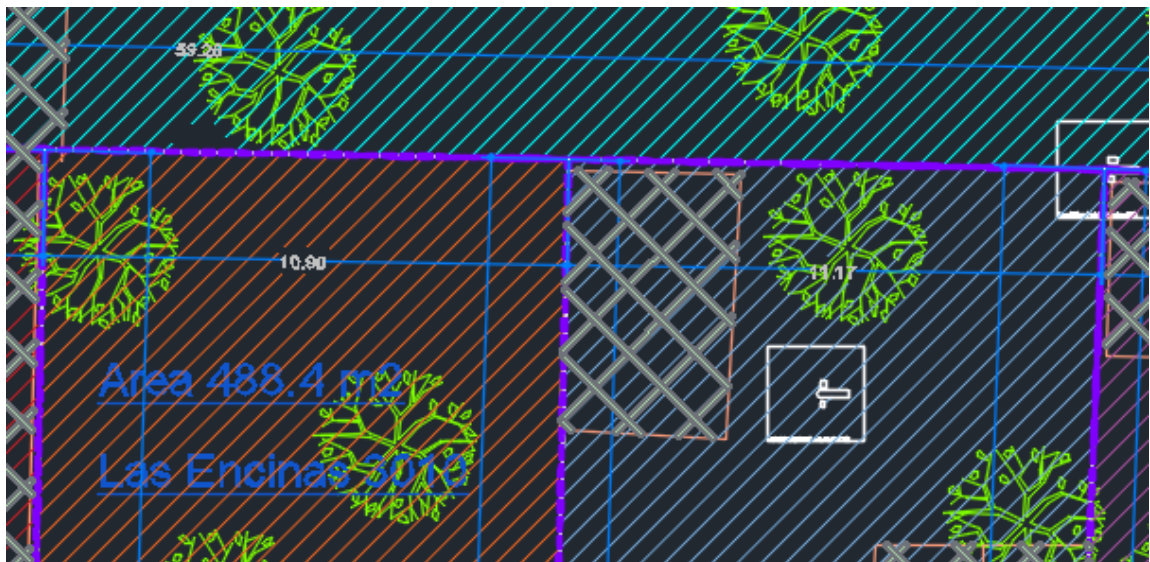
Ubicación levantamiento topográfico calle las encinas.
